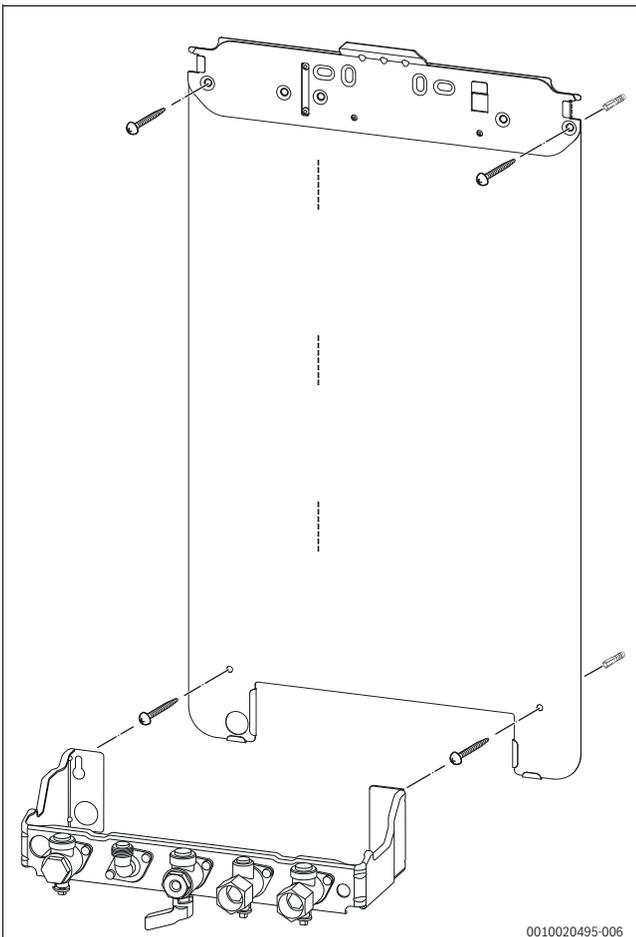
Montage de la plaque de fixation et de la plaque de montage pour le raccordement
